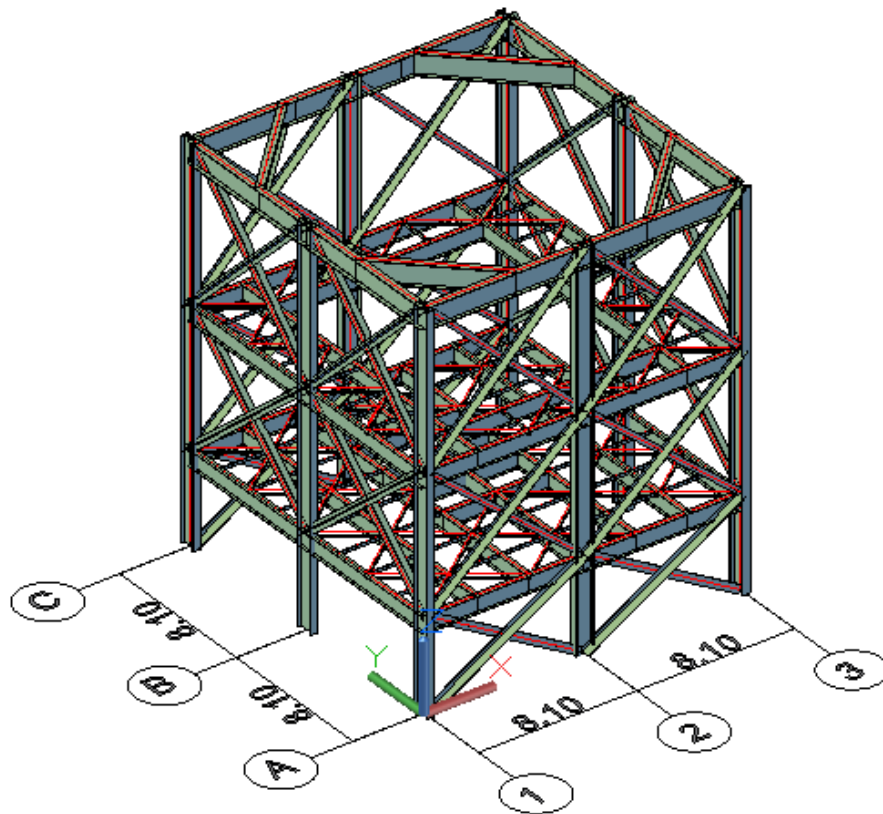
Dimensiones de la planta de la estructura de soporte del silo (m).
